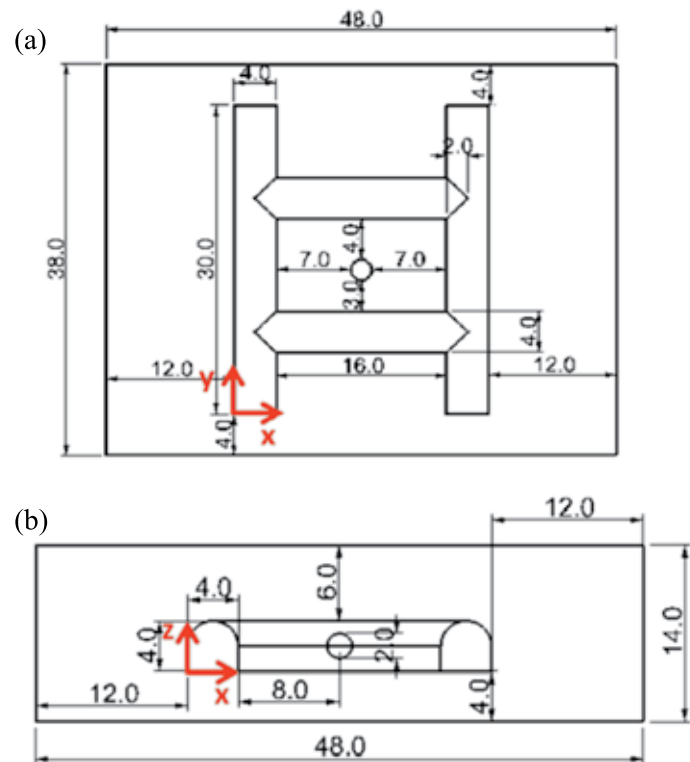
a) Planta y b) vista frontal de la excavación, foco y bordes del modelo realizado, dimensiones en m
